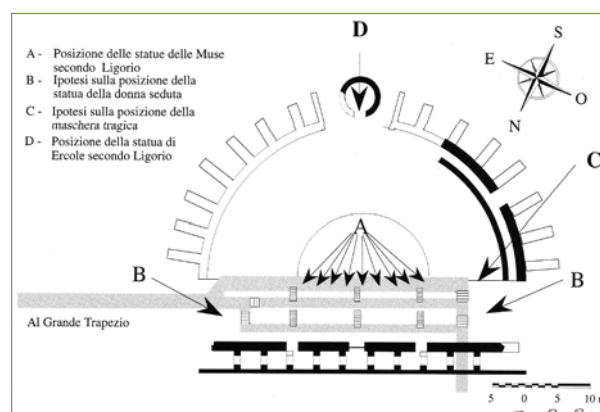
Planta del "odeón" de Villa Adriana, con detalle de las substrucciones (SALZA PRINA RICOTTI 2001: 294).
